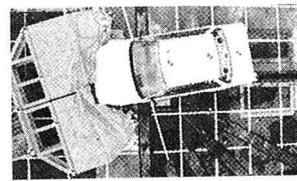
衝突直後(No3) 写真-5 車両損傷状況(No3)
